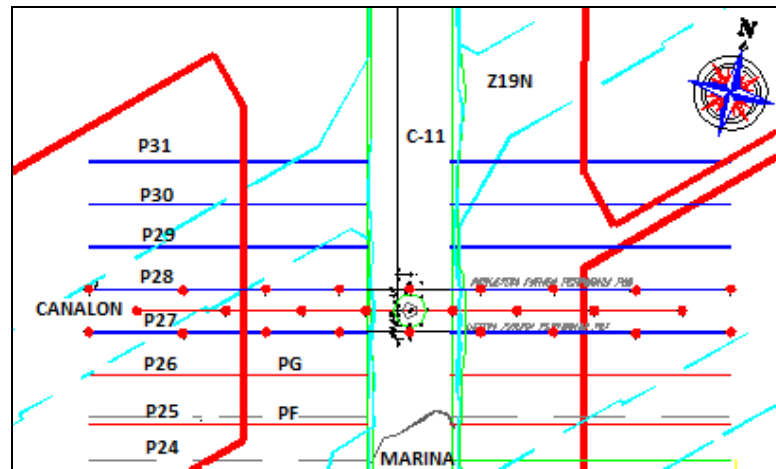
Diseño slot, vista en planta (Superintendencia Mina Norte (c) 2014).
